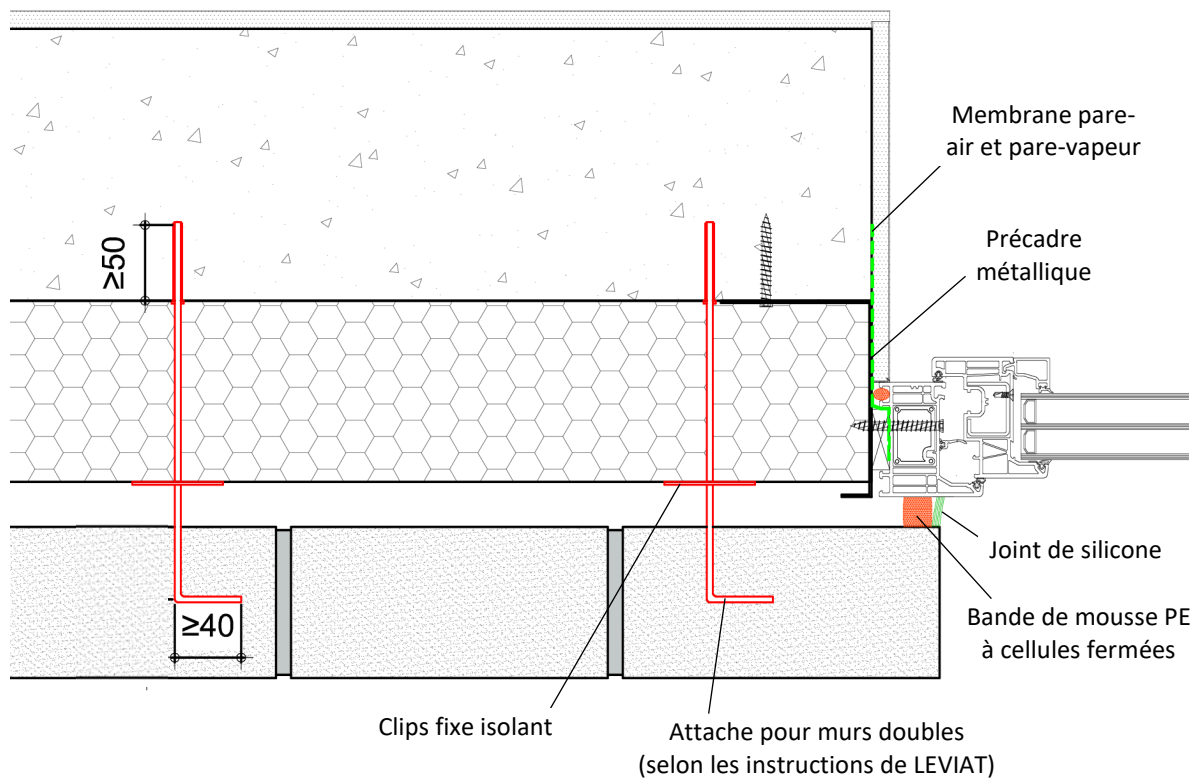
Traitement autour d'une menuiserie à côté d'une fenêtre (installée sur un précadre) - attaches pour murs doubles
